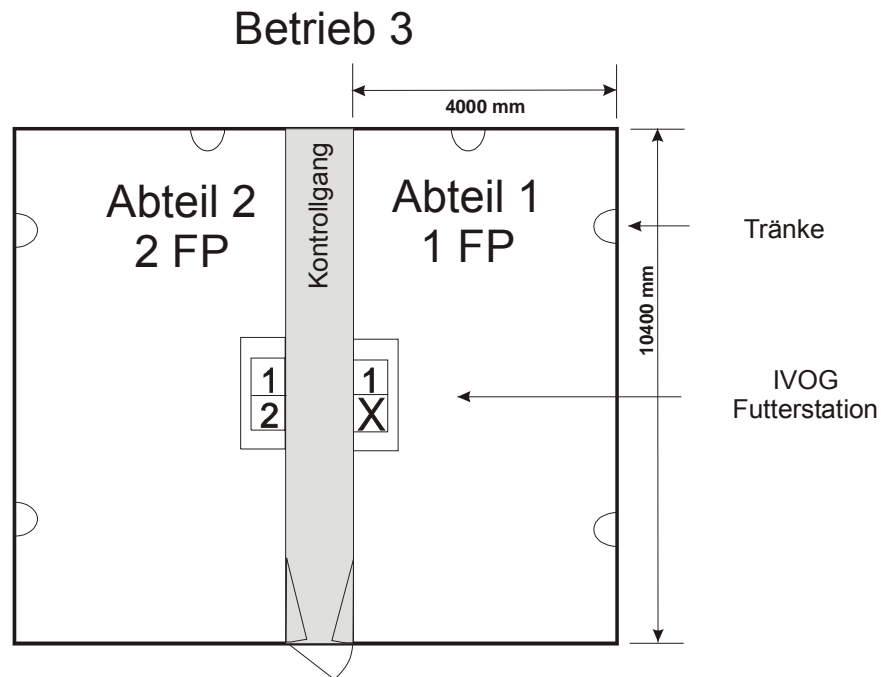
Grundriss der Versuchsbuchten in Betrieb 3
